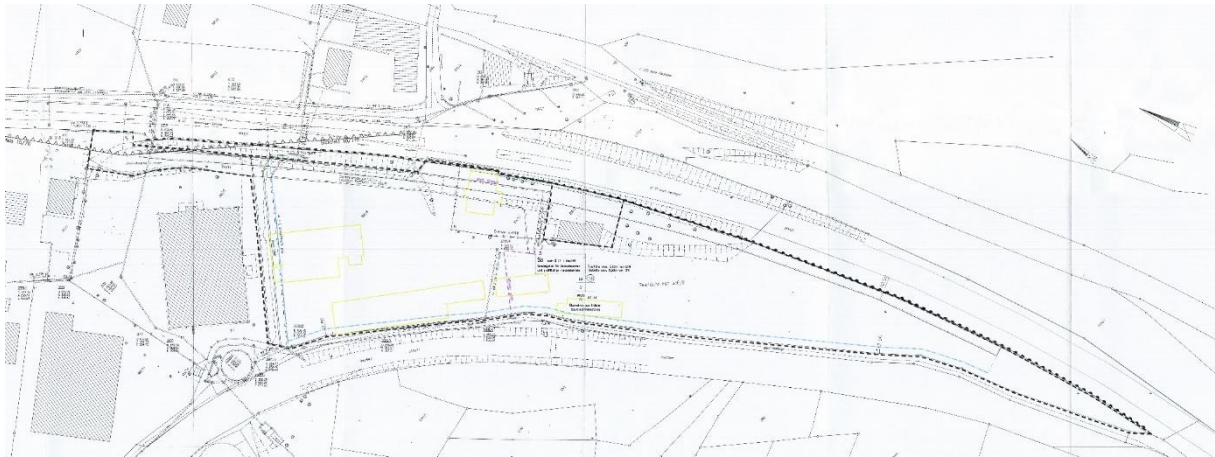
Bebauungsplan „Sigmaringer Straße - Süd“ Februar 2004
